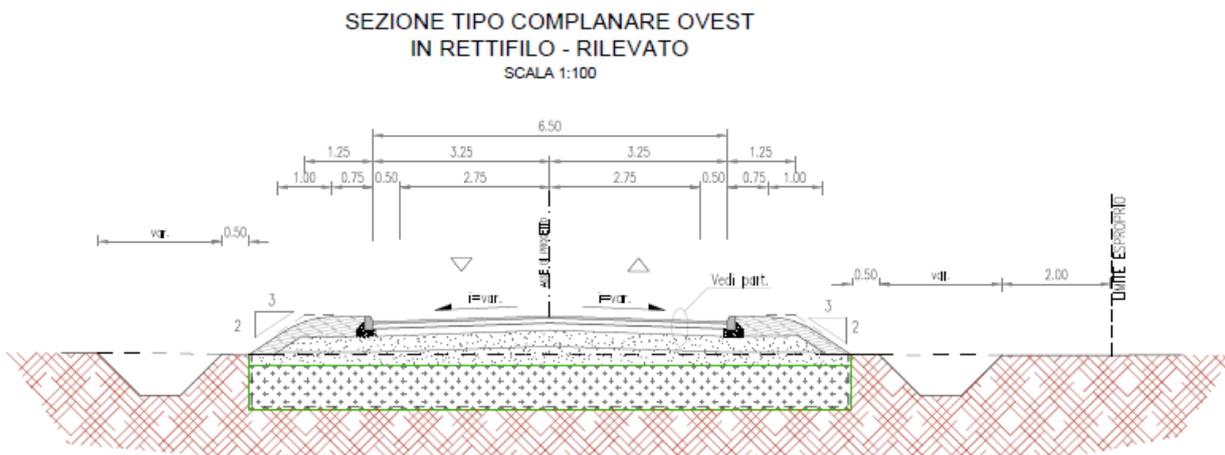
Sezione Tipo Complanare Ovest in rettifilo
